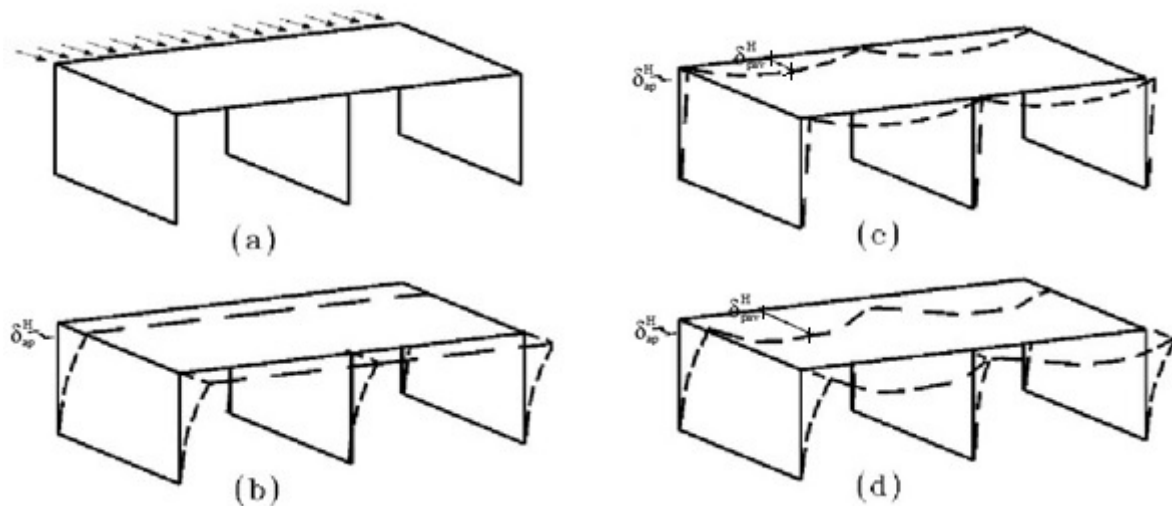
a) Tipologias dos pavimentos face à deformabilidade no plano; b) pavimento rígido; c) pavimento flexível e d) Pavimento semi-flexível (Naeim e Boppana, 2001)
